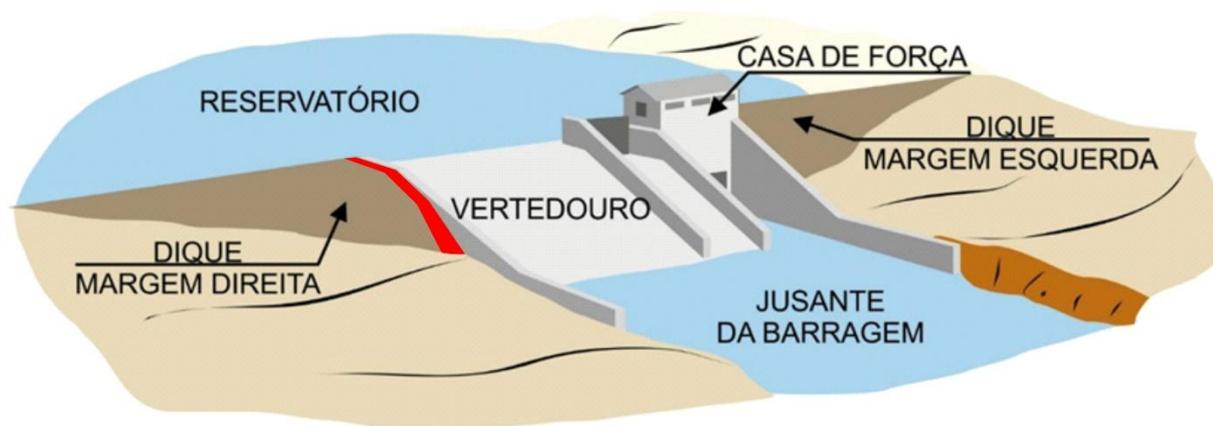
Aparecimento de fissuras. (Fonte: COBA, S.A.)
